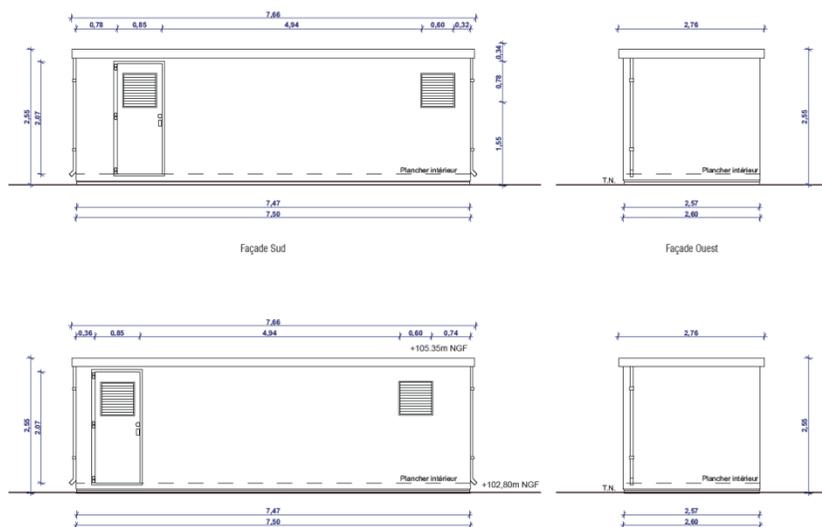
exemple de plans d'un poste de livraison (source EDF EN)
